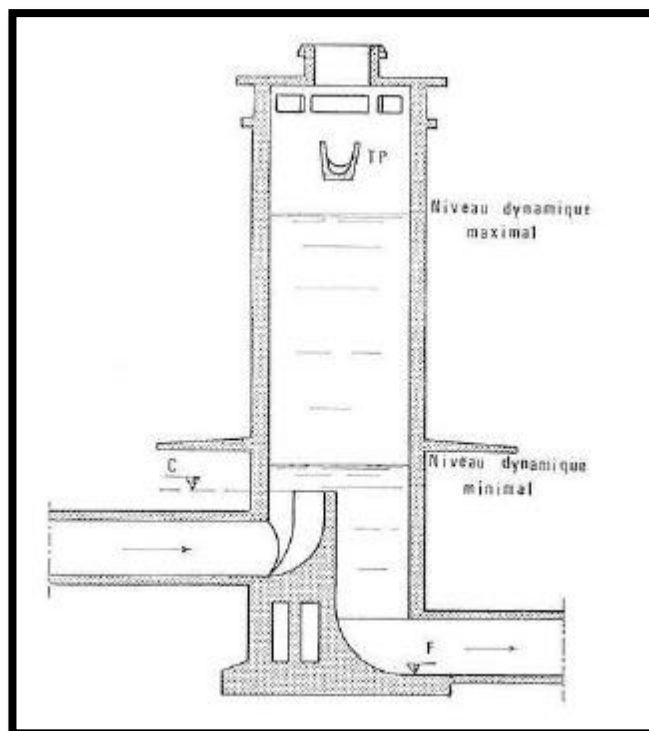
Vue en plan d'une cheminée d'équilibre
